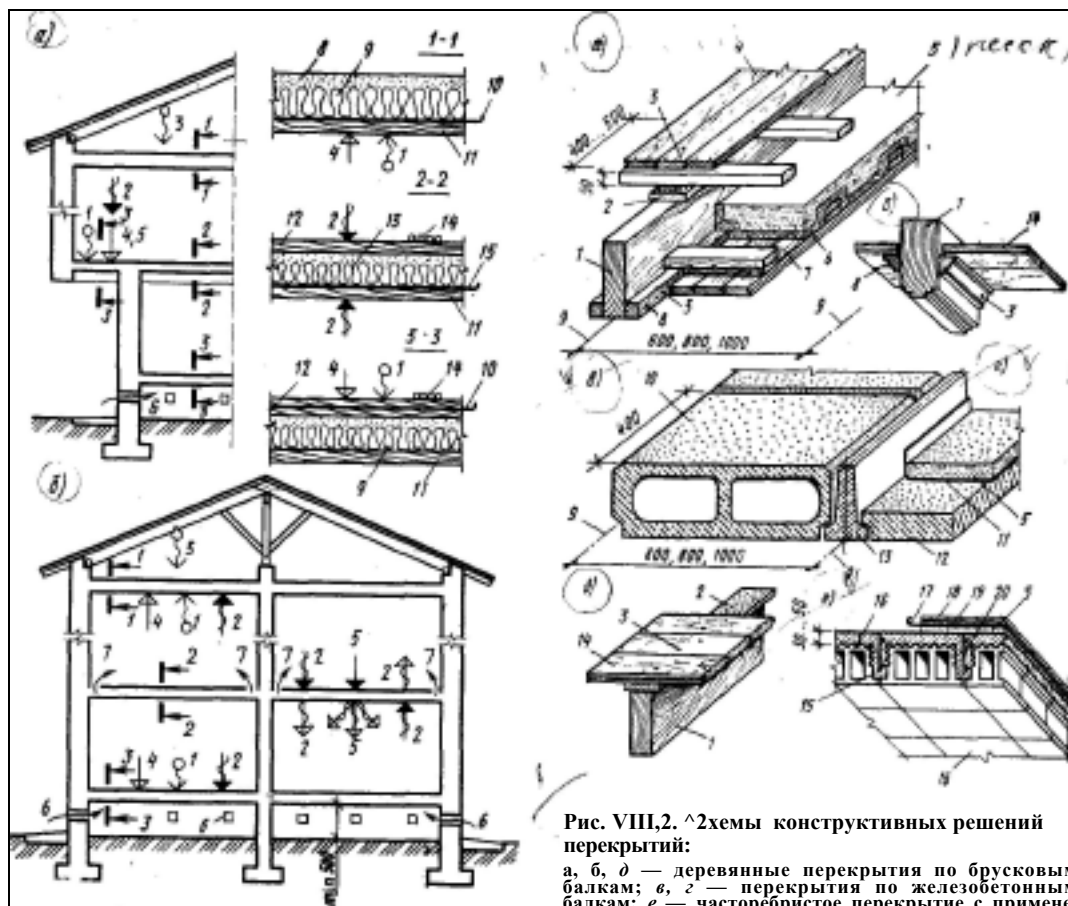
^2хемы конструктивных решений перекрытий:
